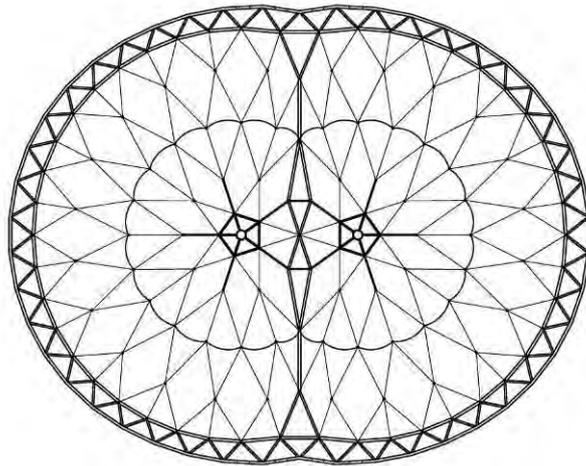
Planta del anillo de compresión, red de cables y arco central, Estadio Ciudad de La Plata.
